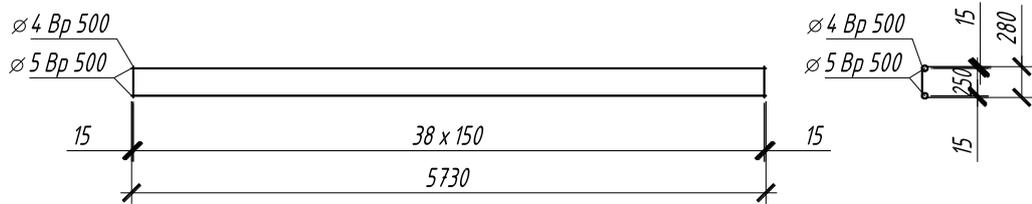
Каркас КРЗ поздовжнього ребра плити покриття
